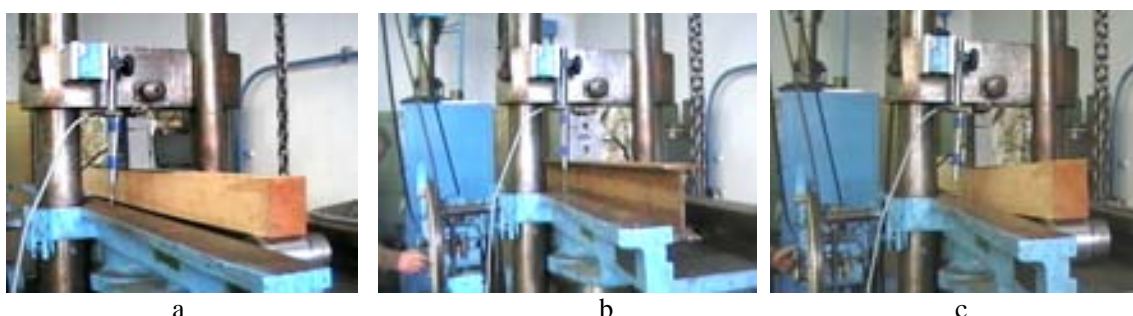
Montajul experimental pentru grindile de referință (CAZUL 1.b și 1.c)
